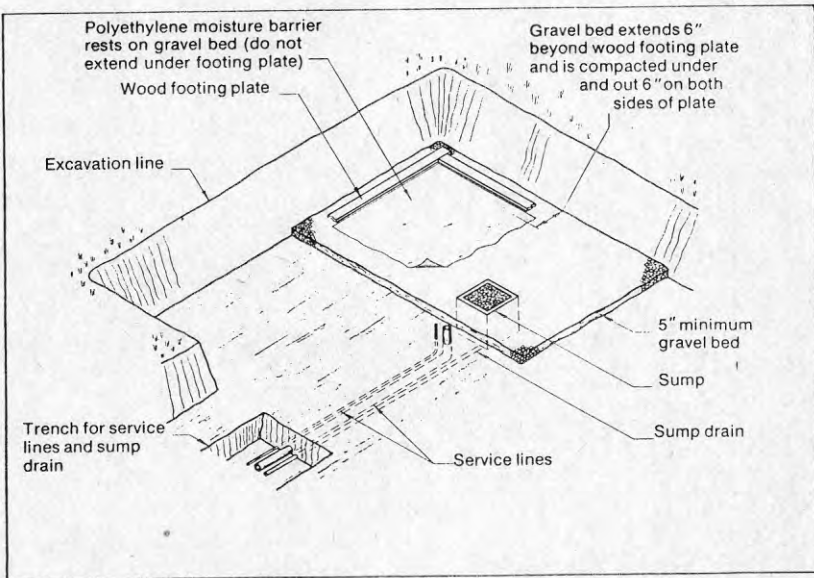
Dränering av undergrunden (Preserved Word Foundations 1976)
